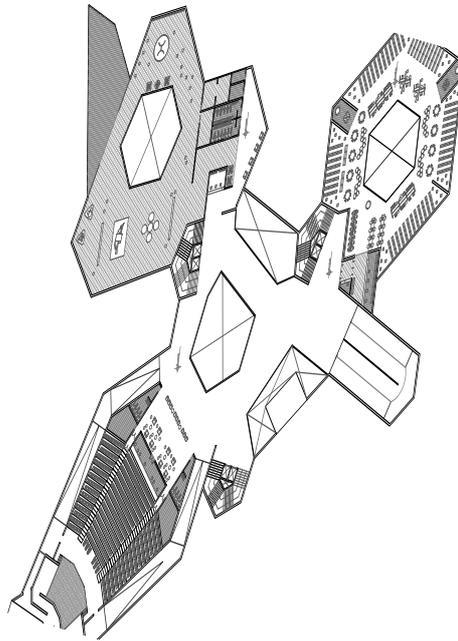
Planta segundo piso sin contexto. Elaboración propia
